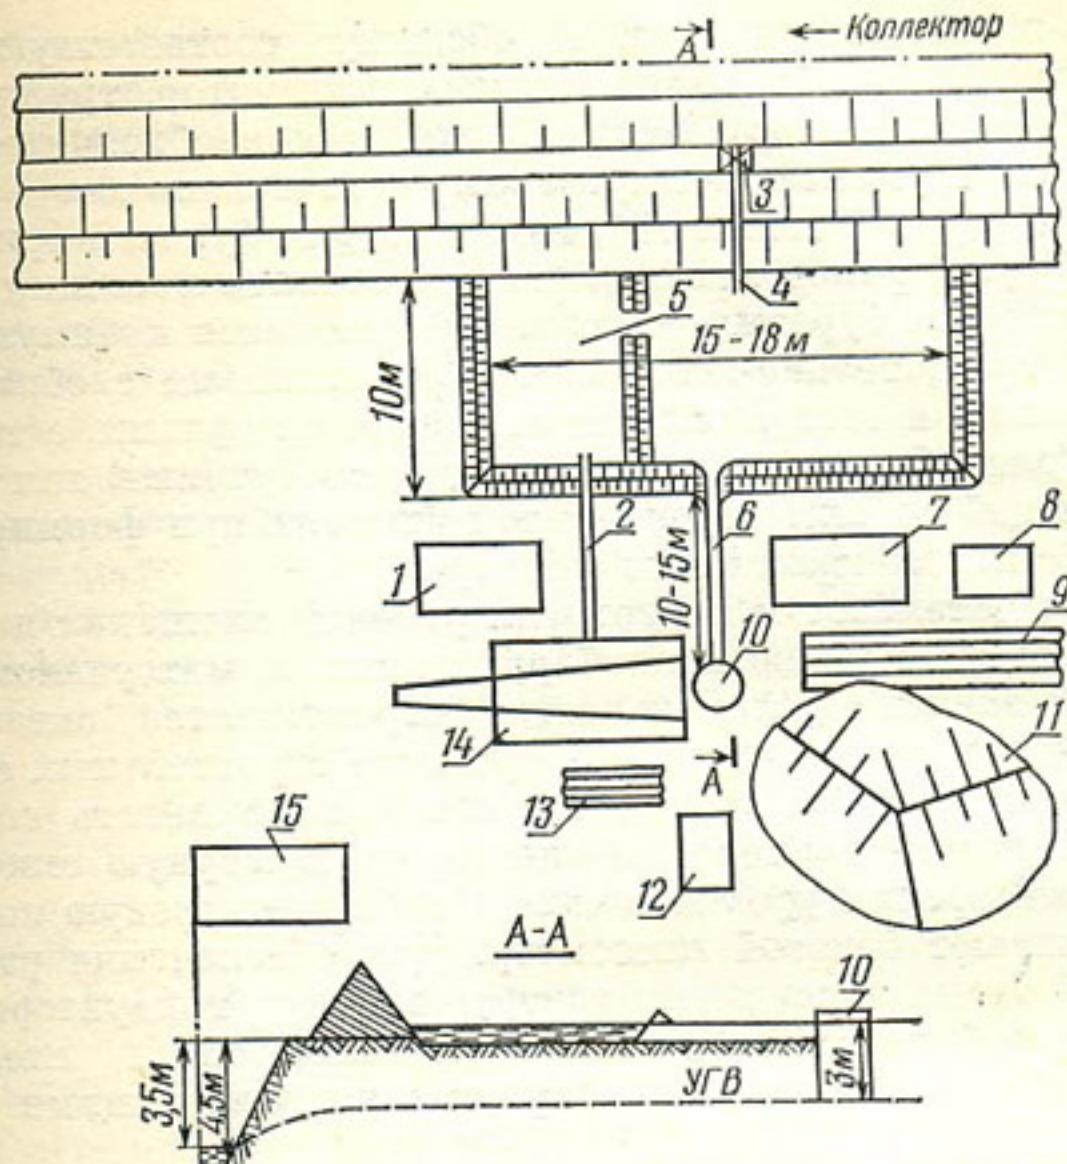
Схема размещения оборудования и материалов на строительной площадке при бурении скважин вертикального дренажа методом обратной промывки (Голодная степь):
